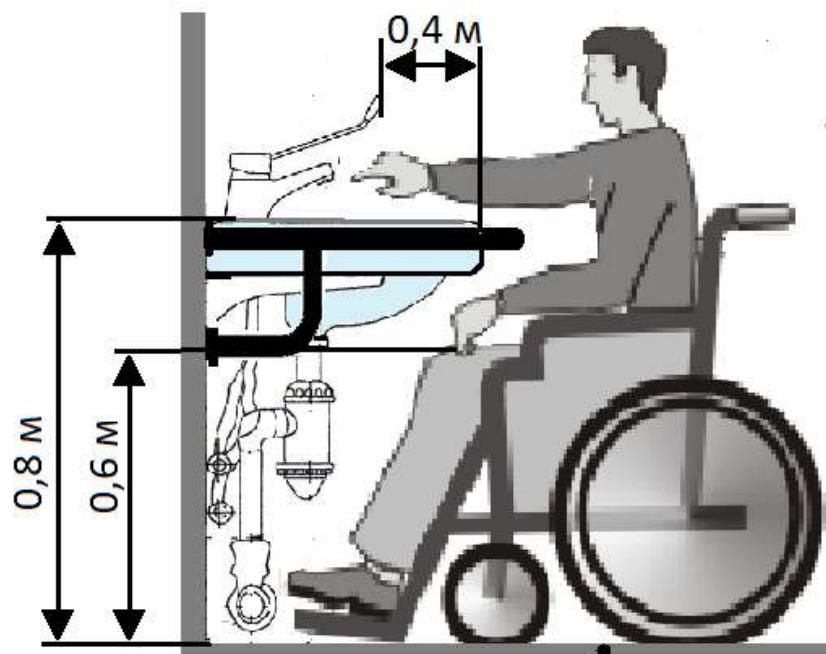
Высота установки раковины для инвалида на коляске
